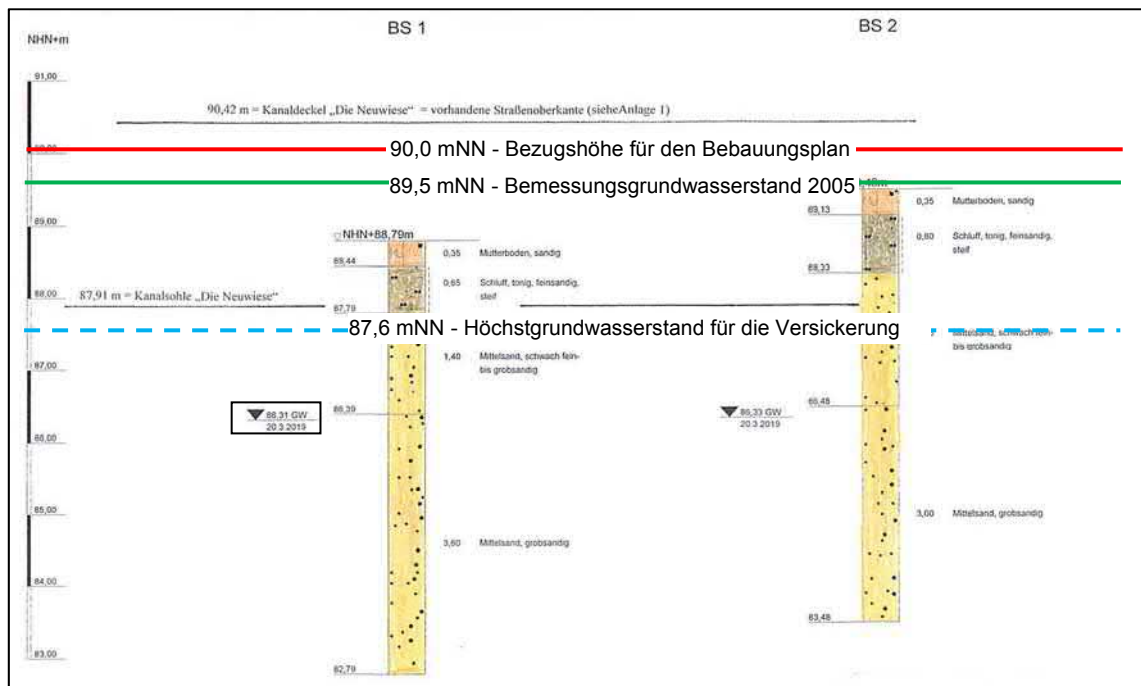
Bohrprofile BS 1 + 2 [Glafe] inkl. Grundwasserbezugshöhen
